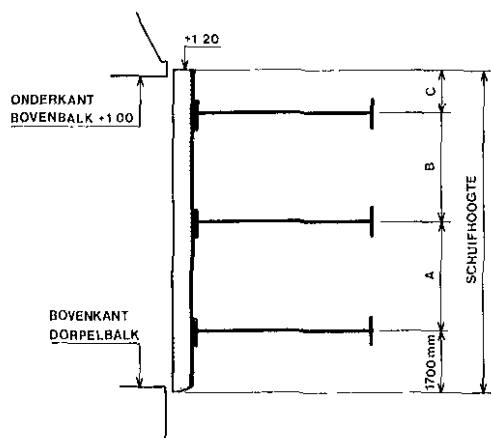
Schema van een schuifconstructie met de beplating aan de Noordzeezijde
